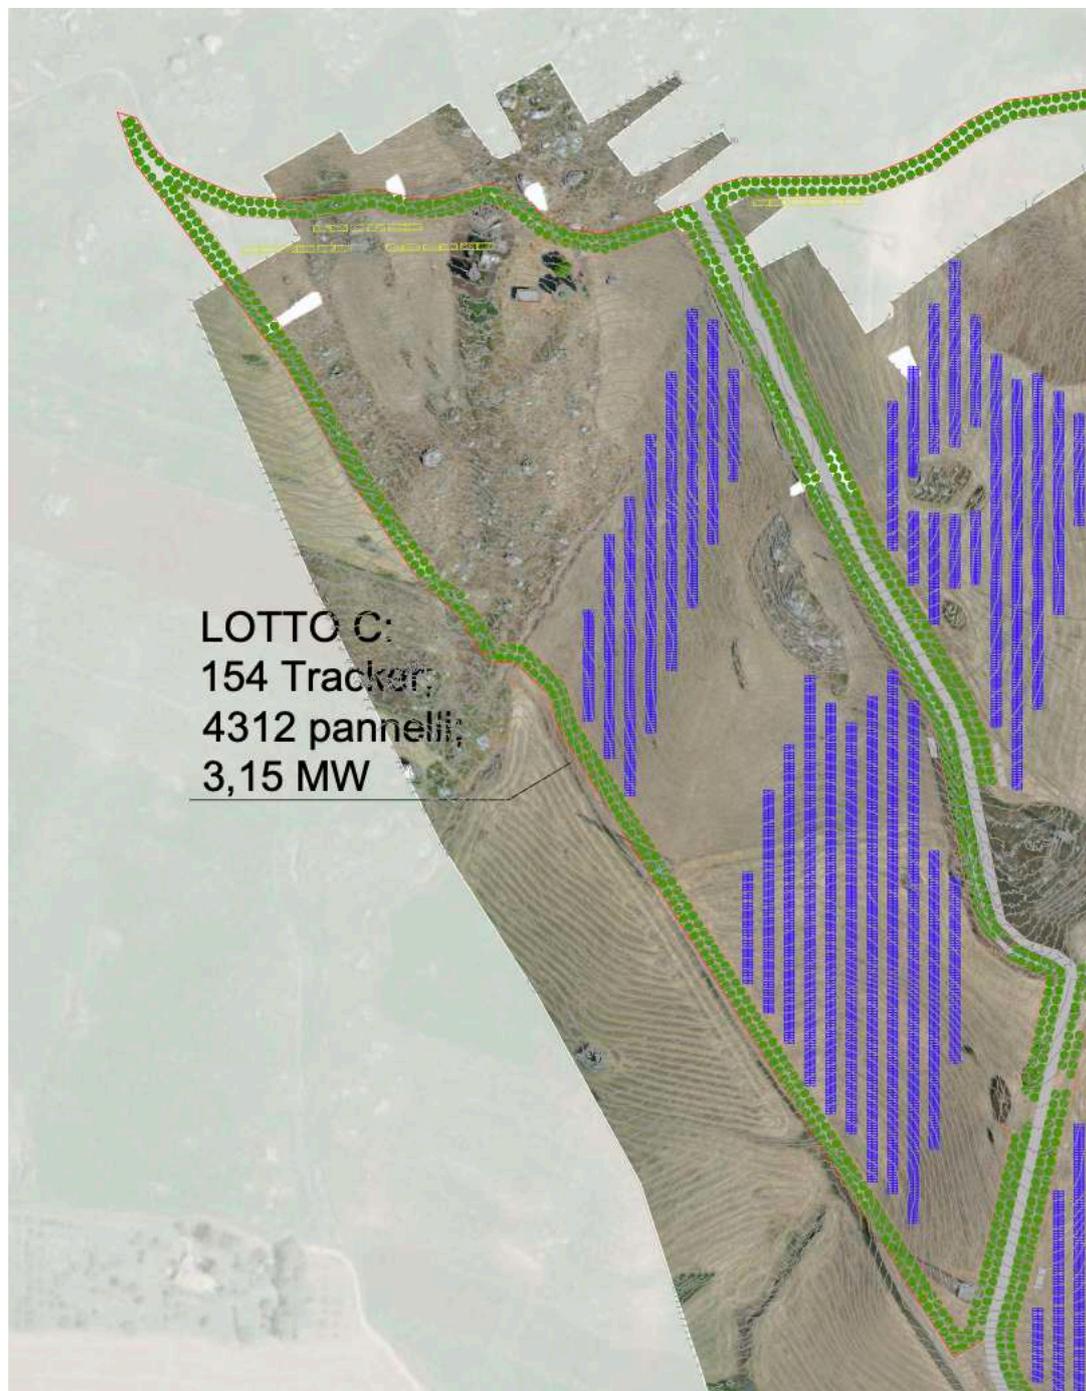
Particolare Layout di impianto area C su stralcio rilievo
